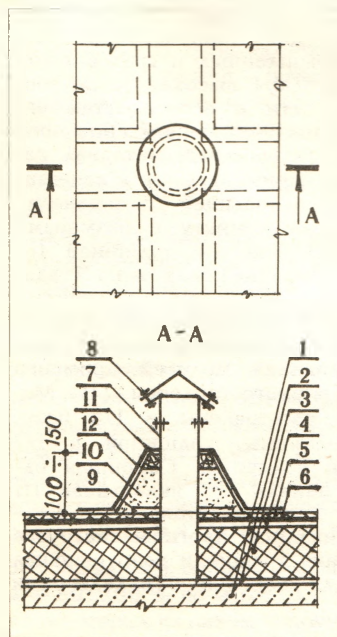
Устройство вытяжки каналов: 1 — 5 - обозначения см. рис. 1; 6 - асбестоцементный лист; 7 - вытягивающий патрубок; 8 - колпак из оцинкованной стали; 9 - фланец, поставленный на горячую мастику; 10 - бортик из цементно-песчаного раствора; 11 - обвязка из антисептированных деревянных брусков; 12 - слои дополнительного водоизоляционного ковра
